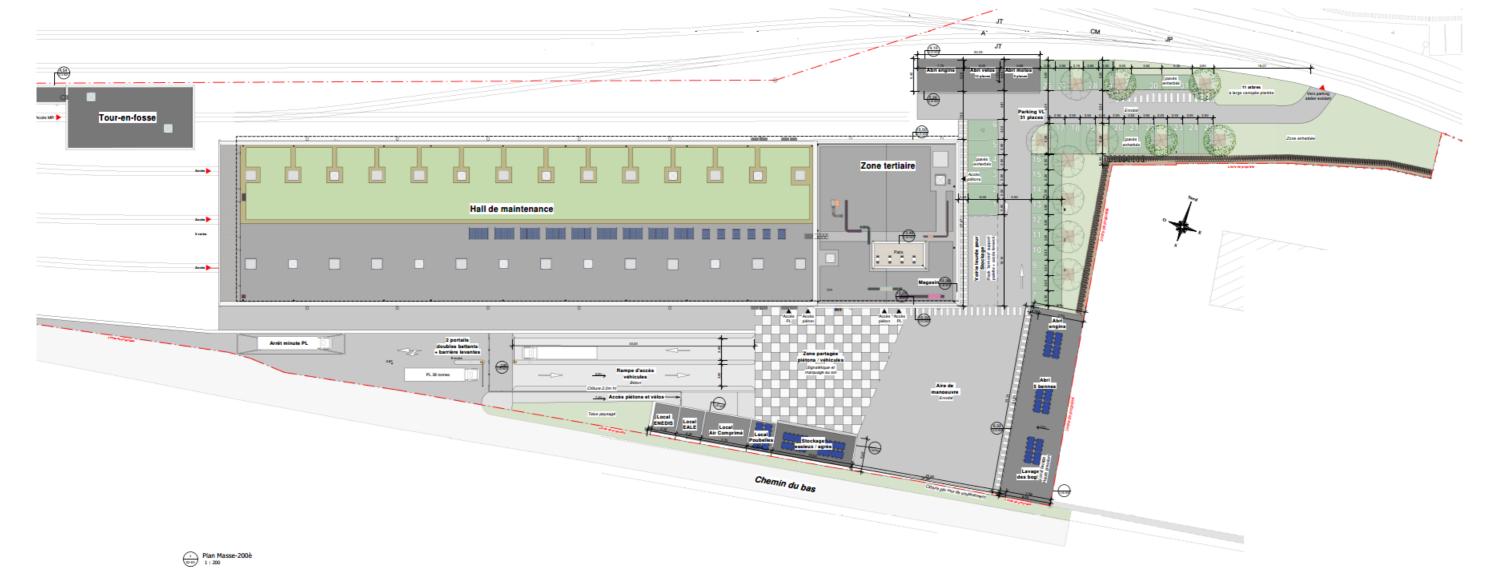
PLAN MASSE DES BATIMENTS (SOURCE ; DOSSIER PRO°
